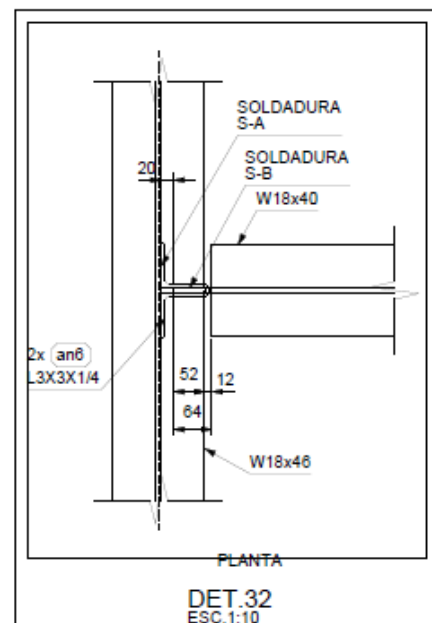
38. Vista en planta de conexión de vigas de entrepiso. Fuente: Planos de taller en Advanced Steel de Grupo Yeril S.A.
